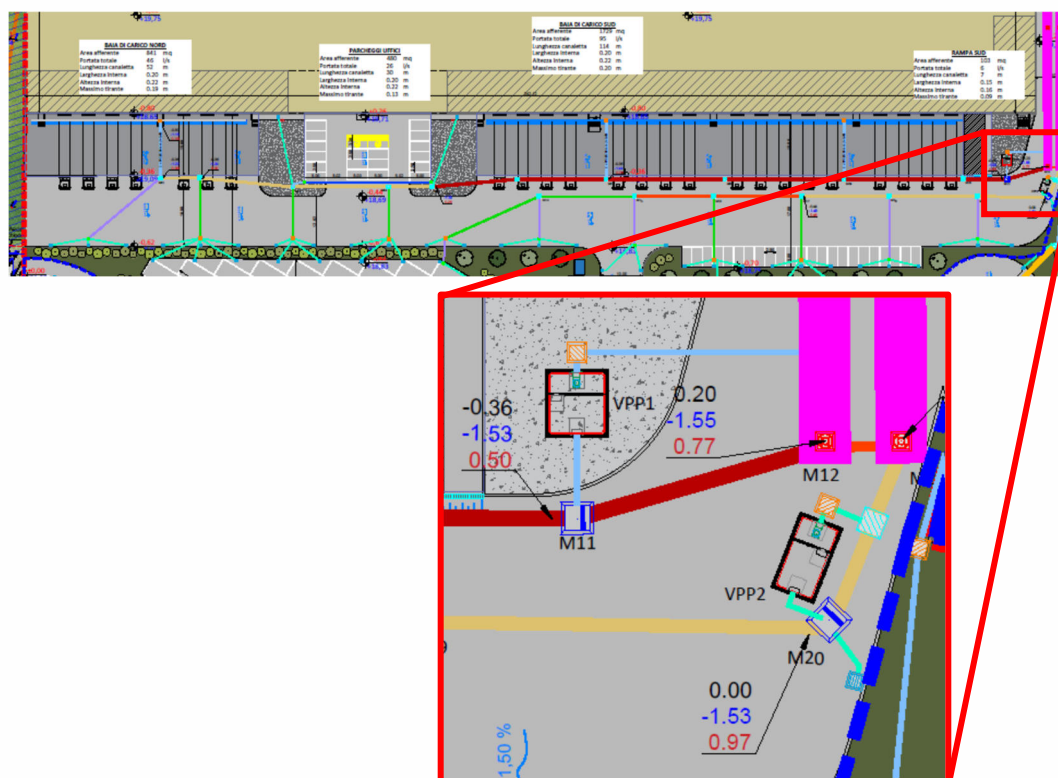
Planimetria della rete di progetto con evidenziate le aree le cui acque collettate sono soggette a trattamento nei 2 impianti previsti.
